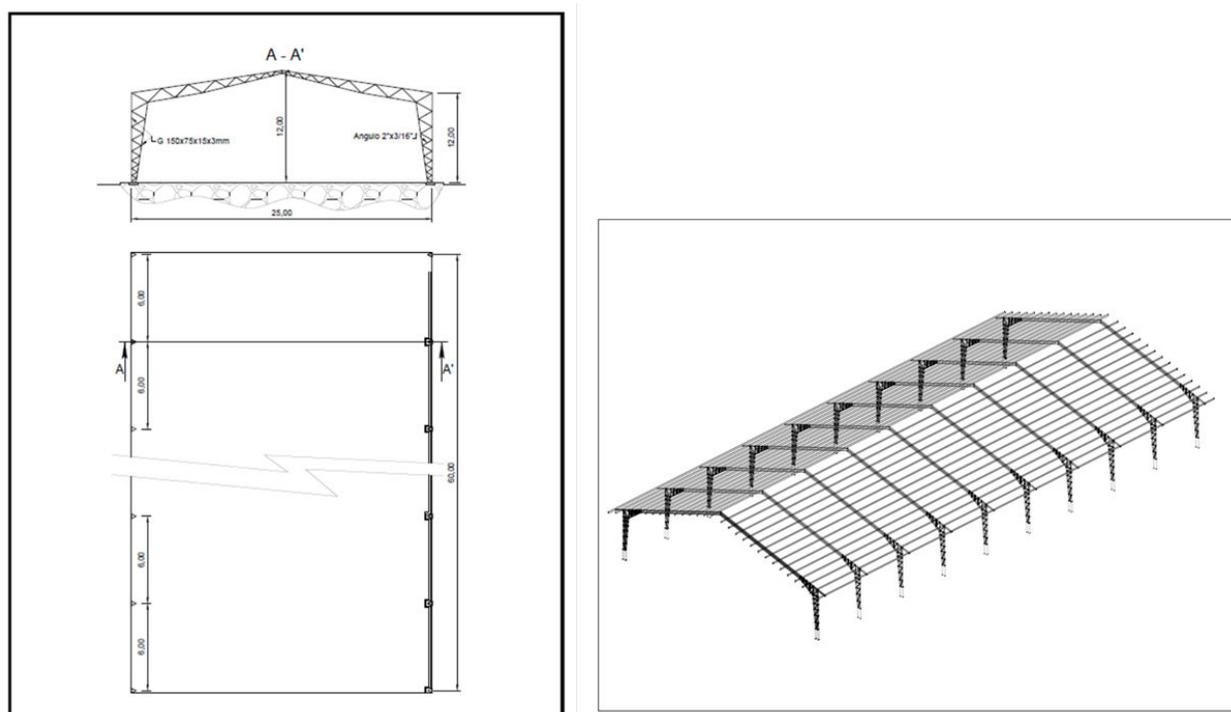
Planos de Galpón para trabajos de soldadura
